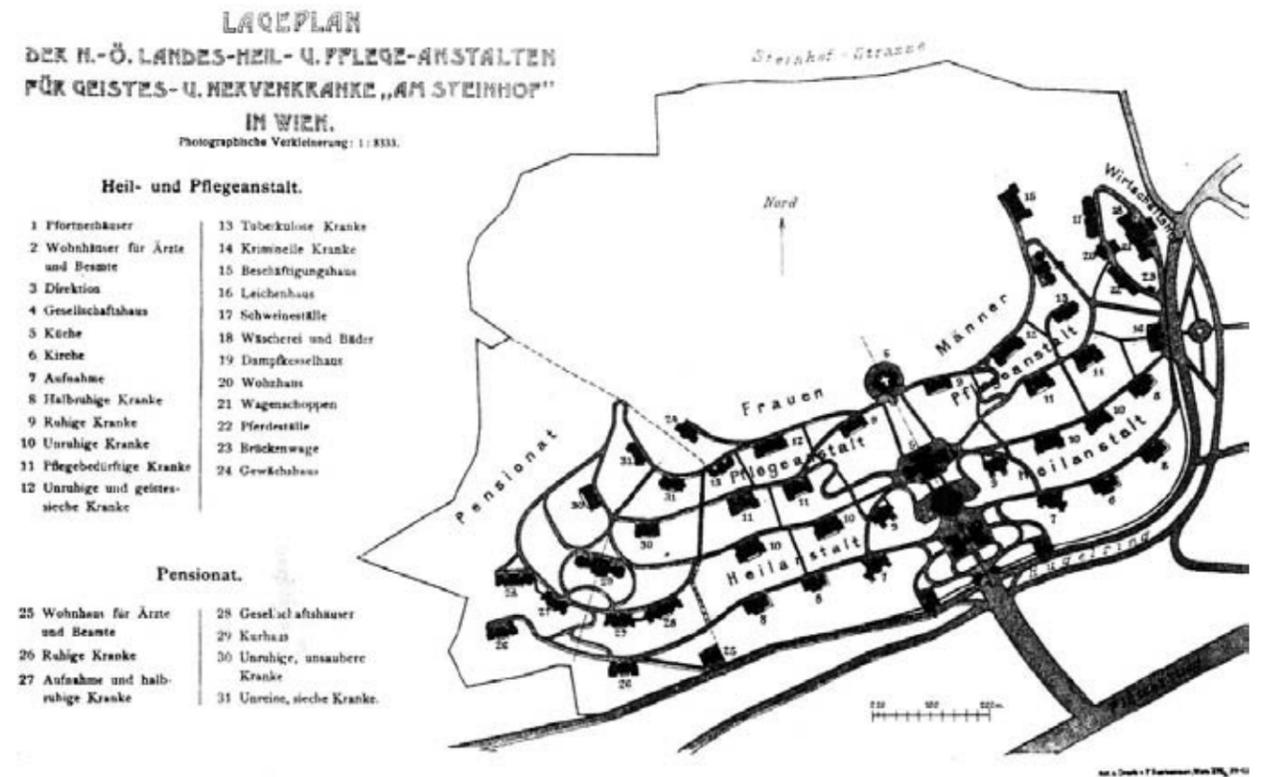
Lageplan Steinhof Entwurf Landesbauamt „Beamtenentwurf“
